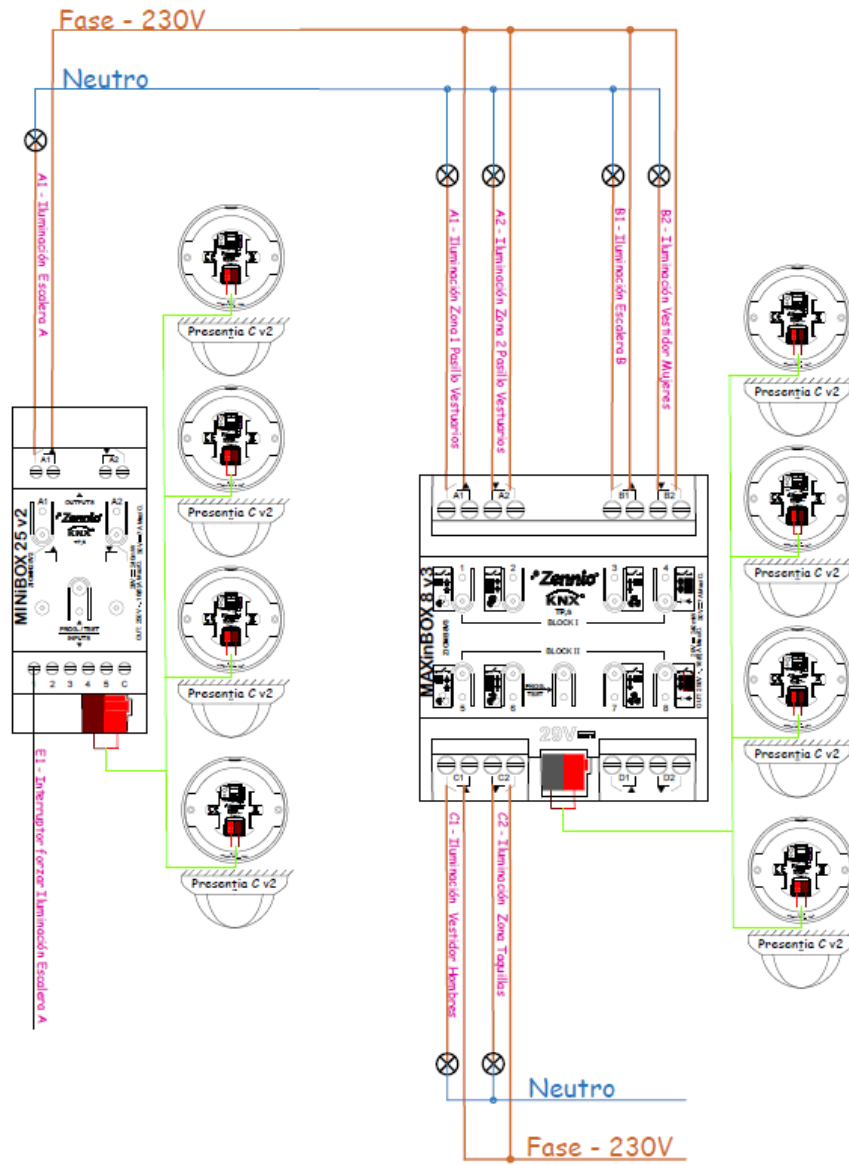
Conexionado de los actuadores proyectado para las escaleras A y B.
